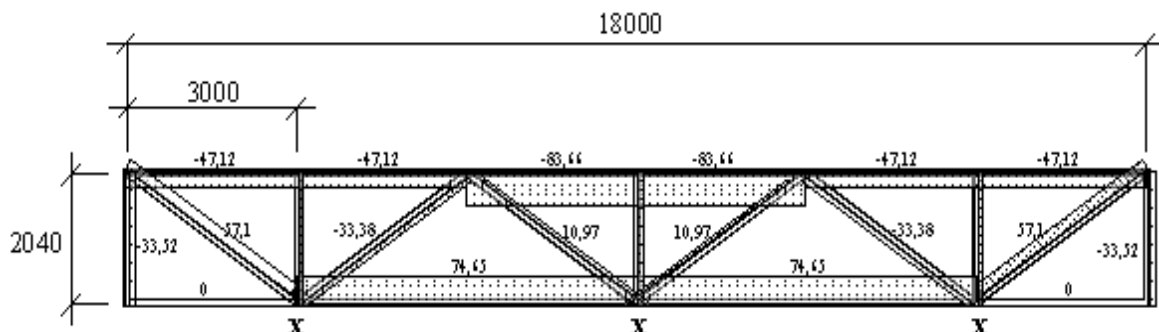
Схема та епюри зусиль залізобетонної ферми при рівномірно розподіленому навантаженні 5,50 кПа
